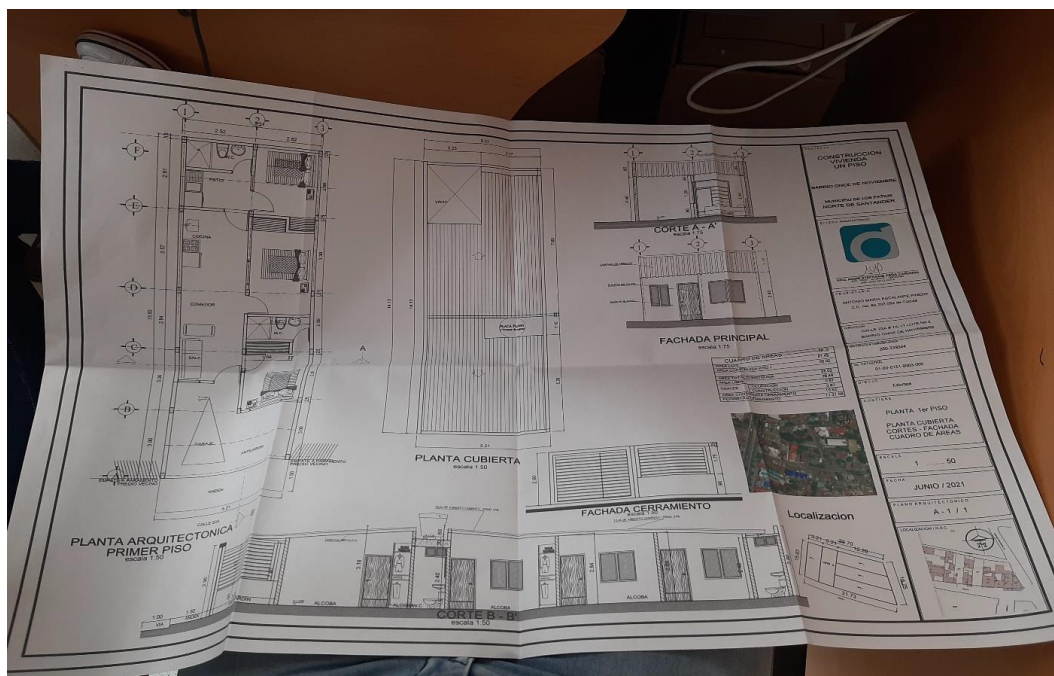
Observación de planos arquitectónicos con sus respectivos detalles
